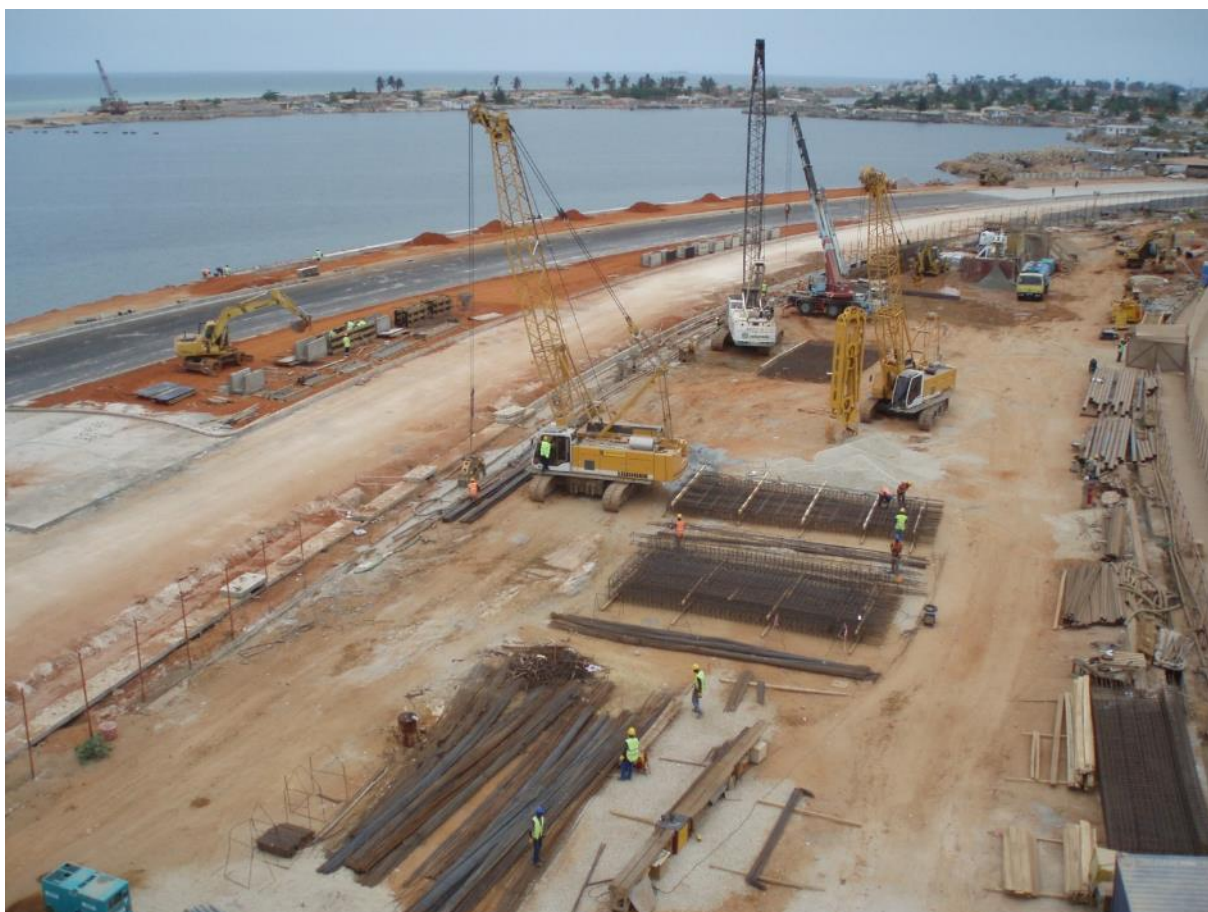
Vista geral do equipamento utilizado na construção da parede moldada
